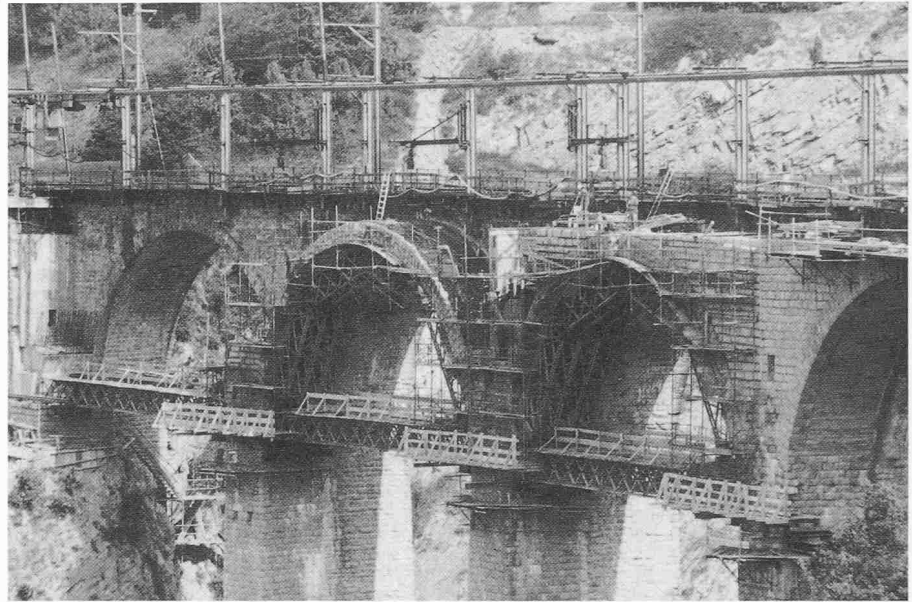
Lehrgerüst für den Überbau und Bauablauf
